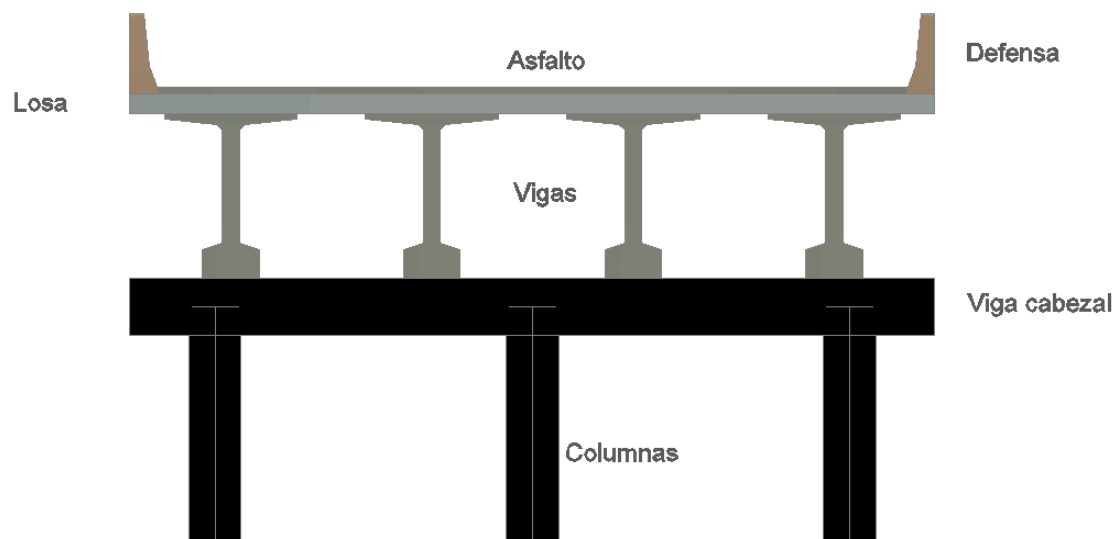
SECCION TRANSVERSAL DEL PUENTE
